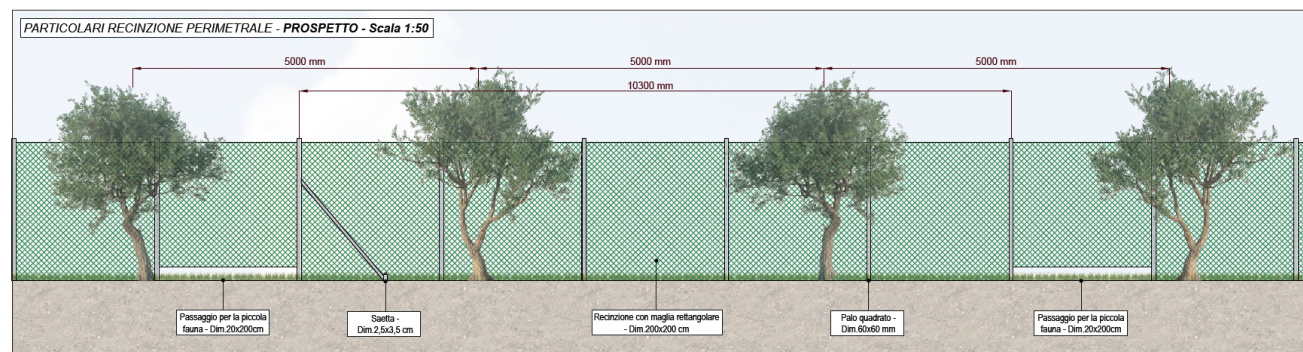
Particolare recinzione perimetrale con passaggio piccola fauna
